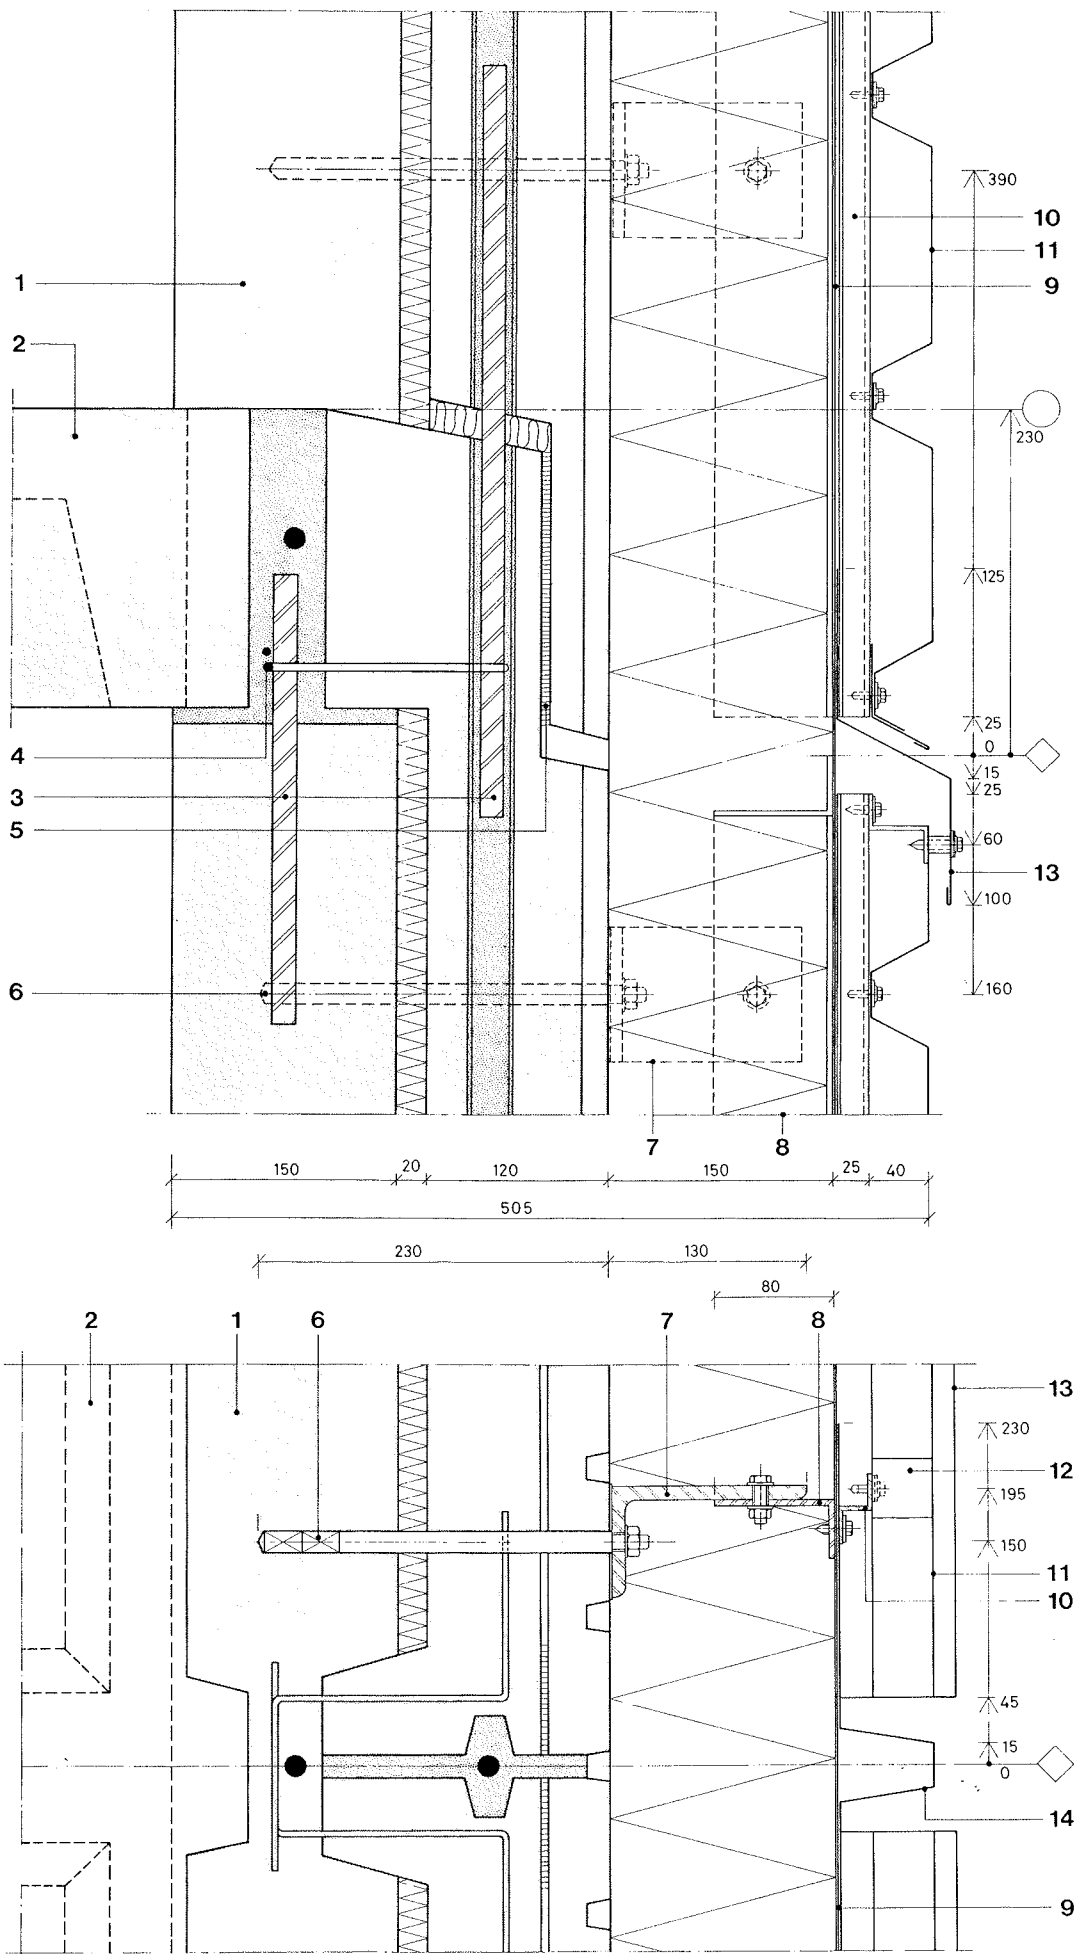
Lodret og vandret snit i efterisoleret gavkonstruktion, 1:5. 1 Gavl-element i beton. 2 Dækelement. 3 Dørne, Ø 16. 4 Låsebøjler. 5 Tjærepap, 5 mm. 6 Klæbeankre, M 10, RF. 7 Alu L 130×75×9, længde = 90. 8 Alu L 80×40×2,6. 9 Vindtæt pap. 10 Alu Z 25×25×25×3. 11 Alu TRP 40. 12 Korrucebånd TRP 40-200. 13 Drypnæseprofil. 14 Samleprofil.
